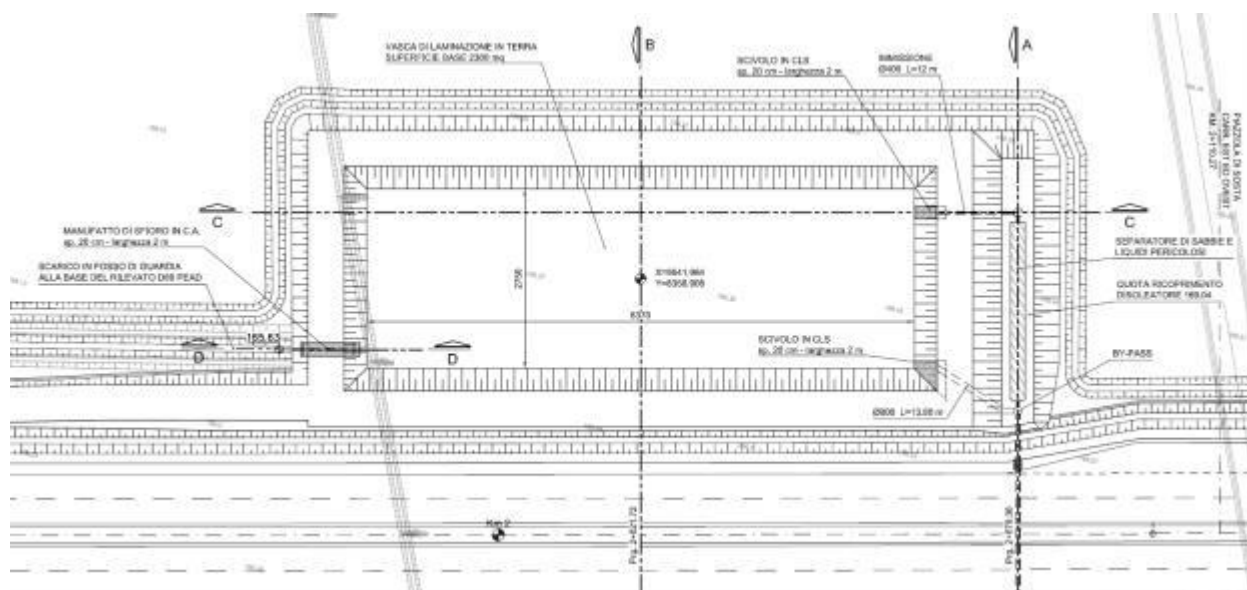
planimetria generale dell'impianto di laminazione A
